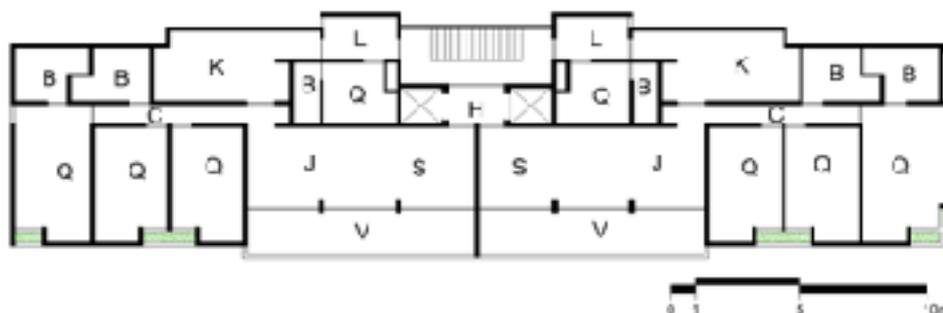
Planta baixa pavimento tipo Edifício Villa Bella.
